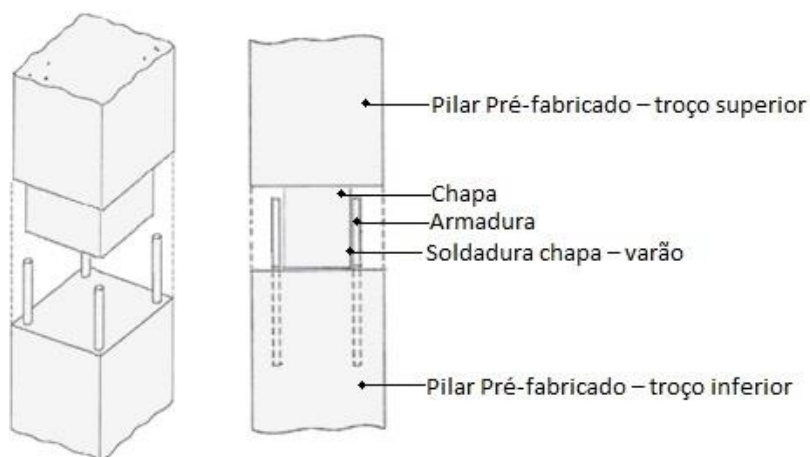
Ligação Pilar – Pilar por soldadura de chapas e varões [46]
